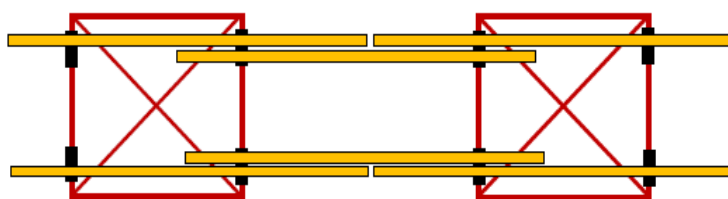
DISPOSITION DES POUTRELLES LISSES
